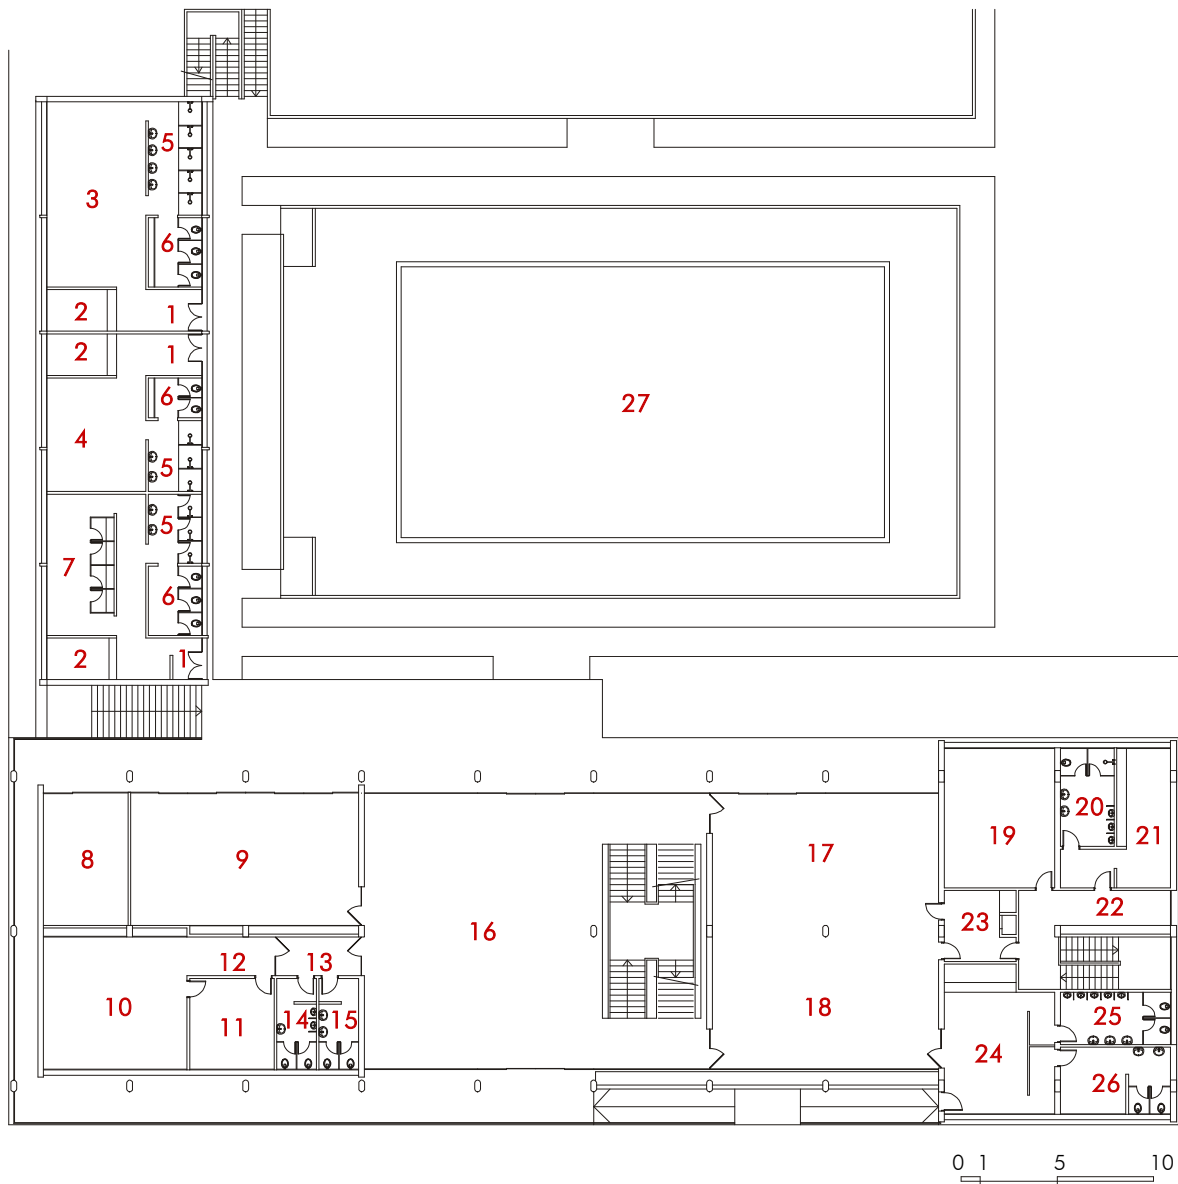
Planta do pavimento térreo: Edifício dos Vestiários, Sede e Piscina.
